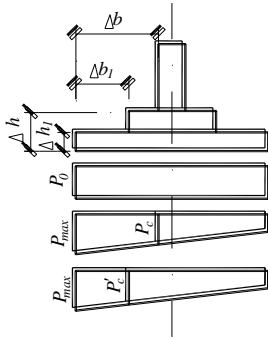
素混凝土基础底板下压时承载力计算简图
